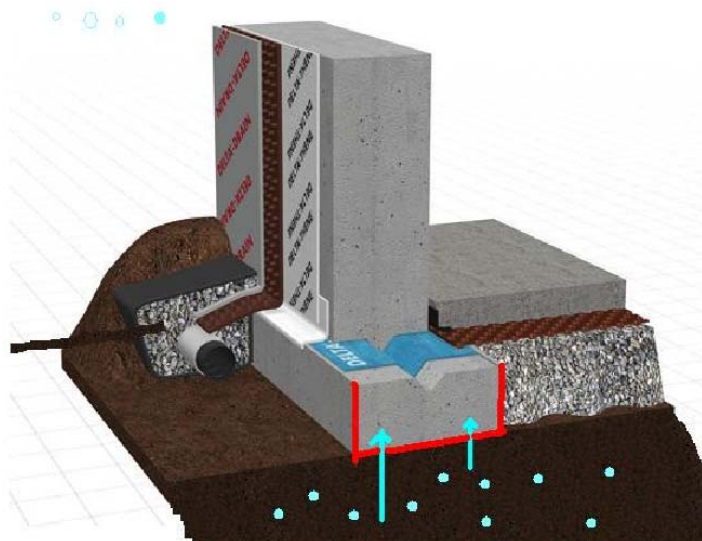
Sistema construtivo de um muro enterrado (Delta-Drain, 2011)
